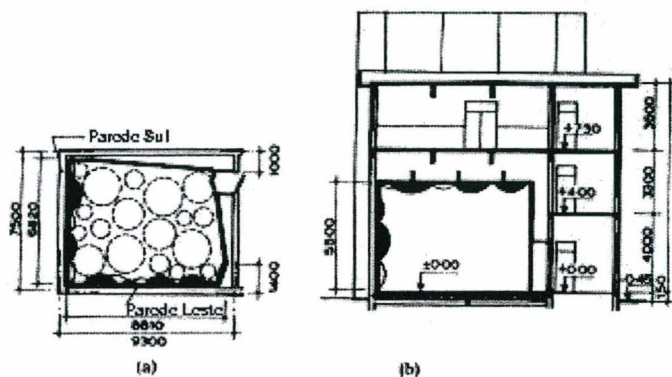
Planta e corte da câmara reverberante do Lab. de eletroacústica de Hangzhou [DUANQI et al. (1991)]
